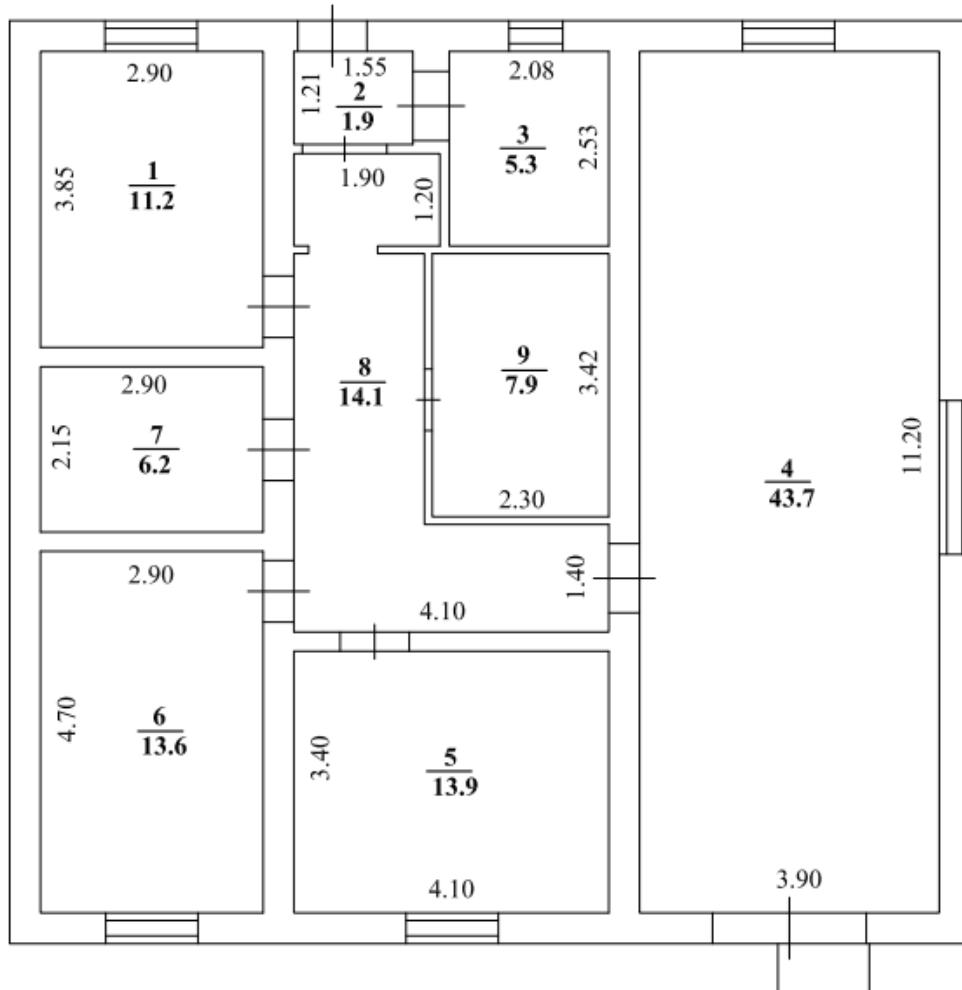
Поэтажный план здания – объекта кадастровых работ
